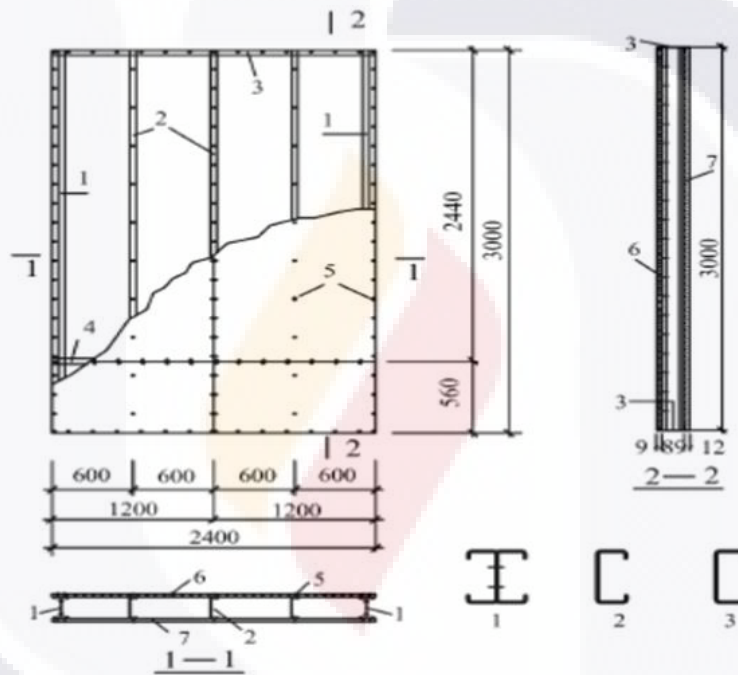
Detalles de la geometría y estructuración de los marcos (Zhou, 2006).
